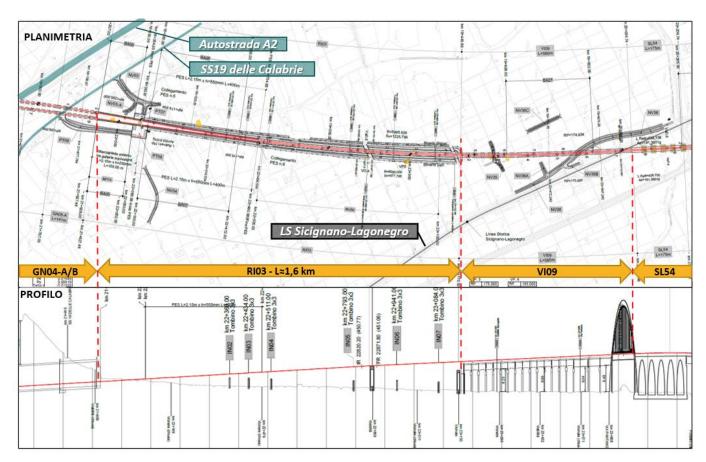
Planoprofilo di progetto da km 21+927 a km 23+755
